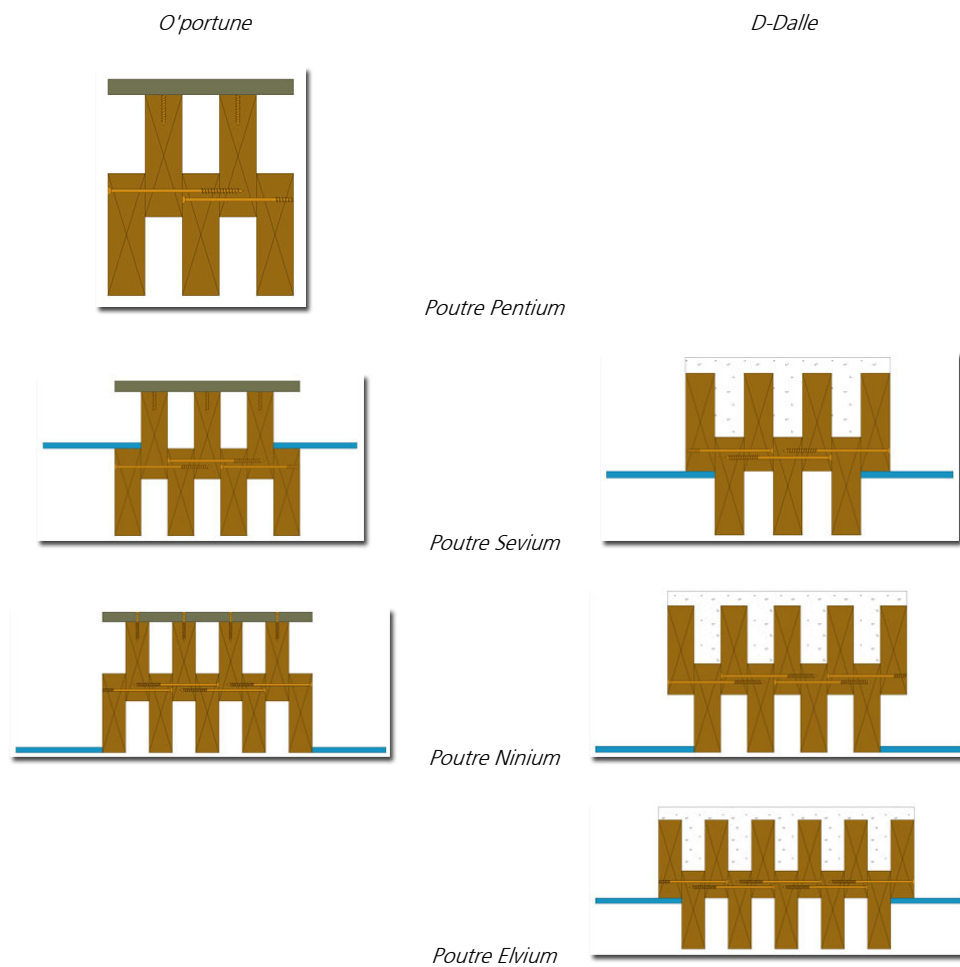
Typologie des poutres pour les dalles en Solivium, avec le type panneau bois et le type bois-béton connecté
